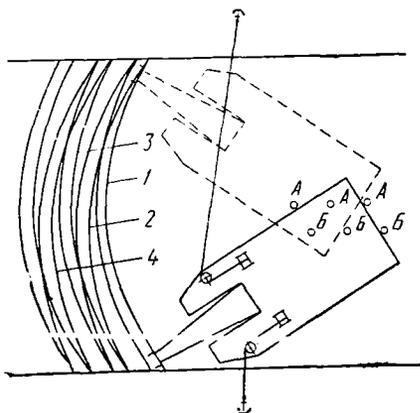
Разработка грунта плавучим снарядом по способу папильонирования:
